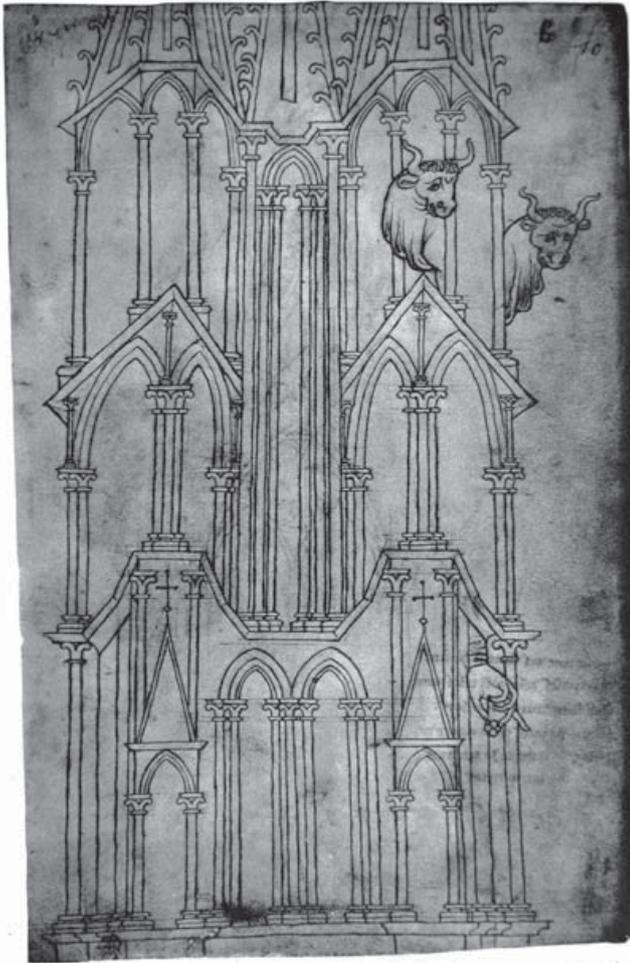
Villard de Honnecourt. Alzado o elevación de la torre de la catedral de Laon.
